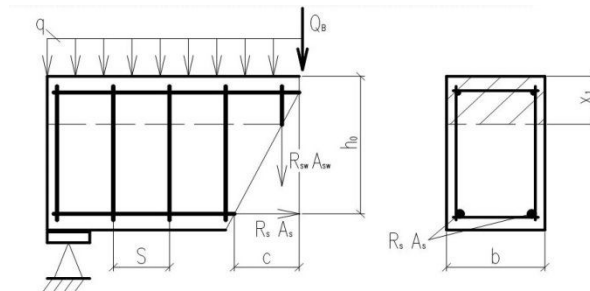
Расчетная схема наклонного сечения изгибаемого элемента
